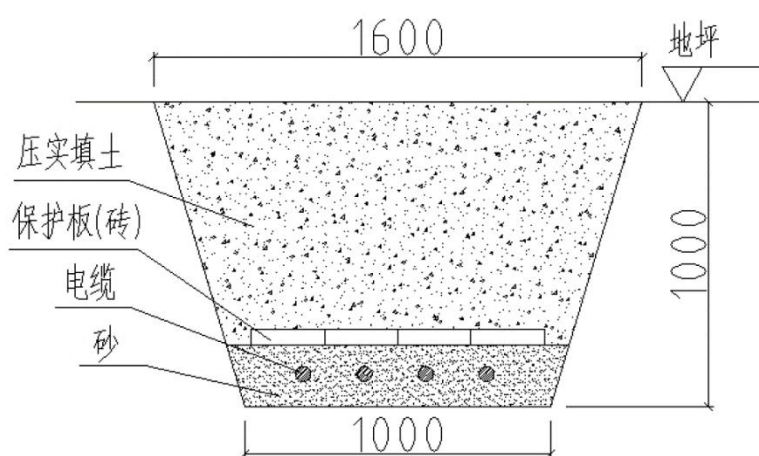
项目直埋电缆典型横剖面图（单位：mm）
